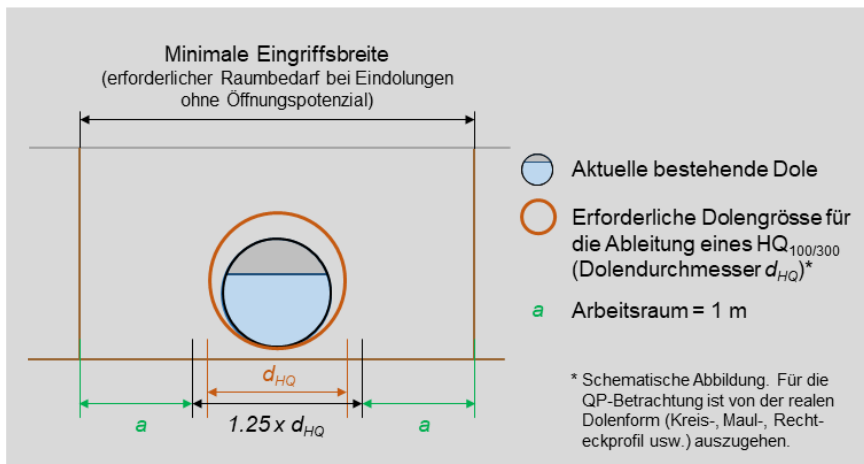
Querschnittsbetrachtung für eingedolte Fließgewässer [2].
